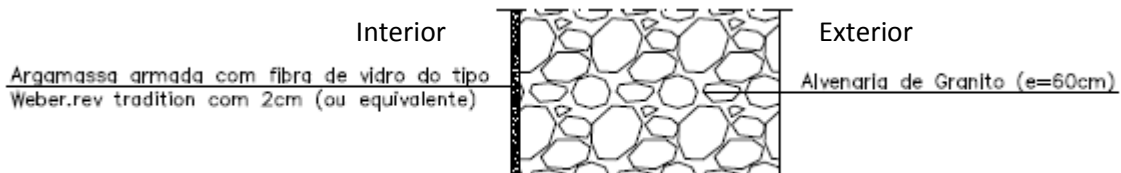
Pormenor construtivo da parede Pe4 [17]
